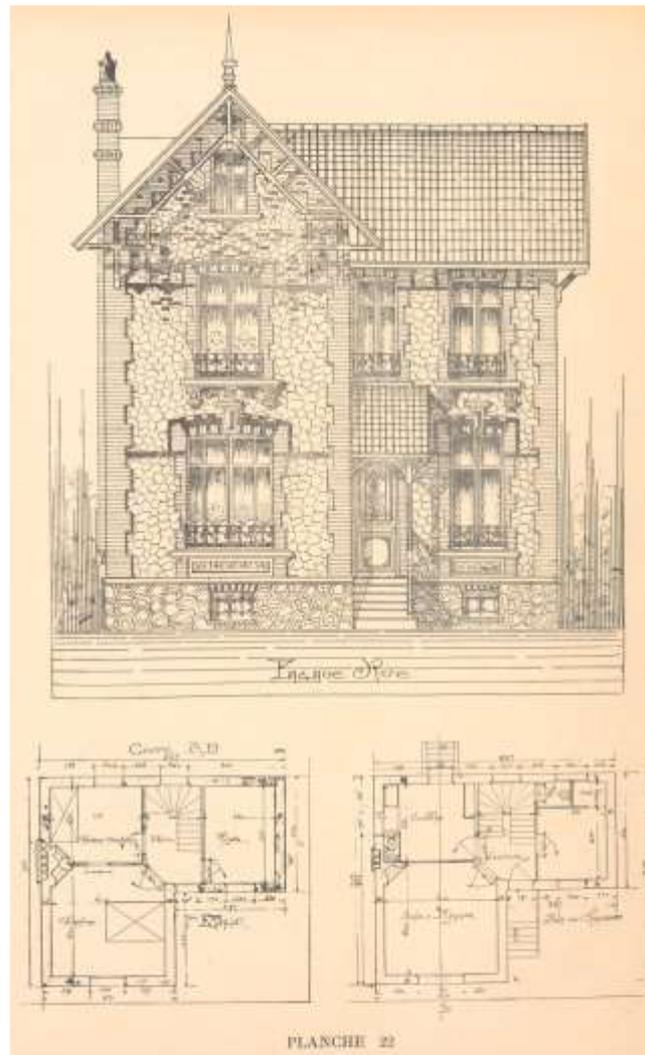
façade et plan d'une villa publiée par Petitpas (Planche 22)
